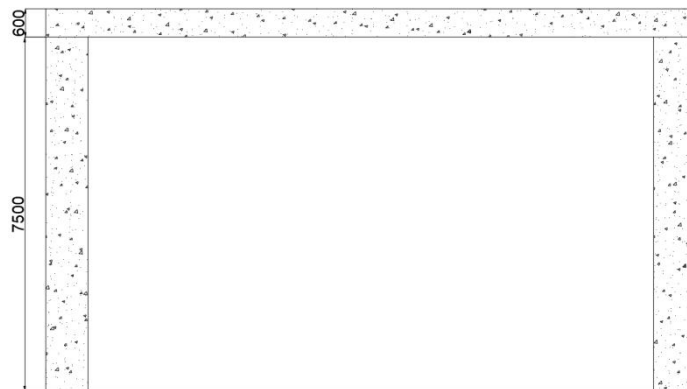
(b) 探伤室1-1剖面示意图 (单位: mm)
